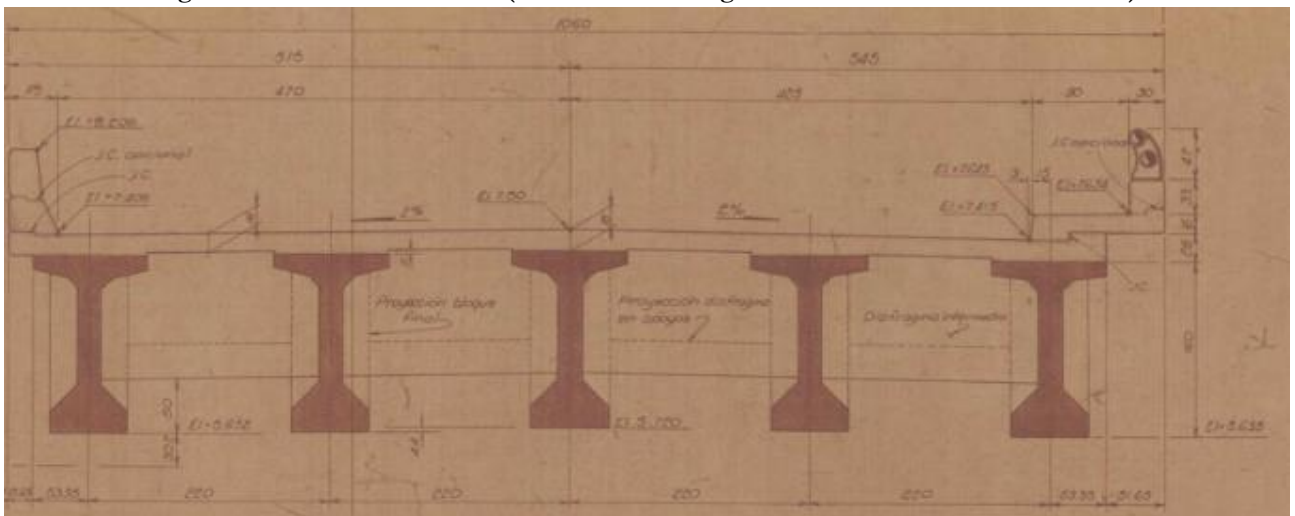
Sección transversal del Puente (Fuente: Planos originales del Puente Barranca Ruta 23)
